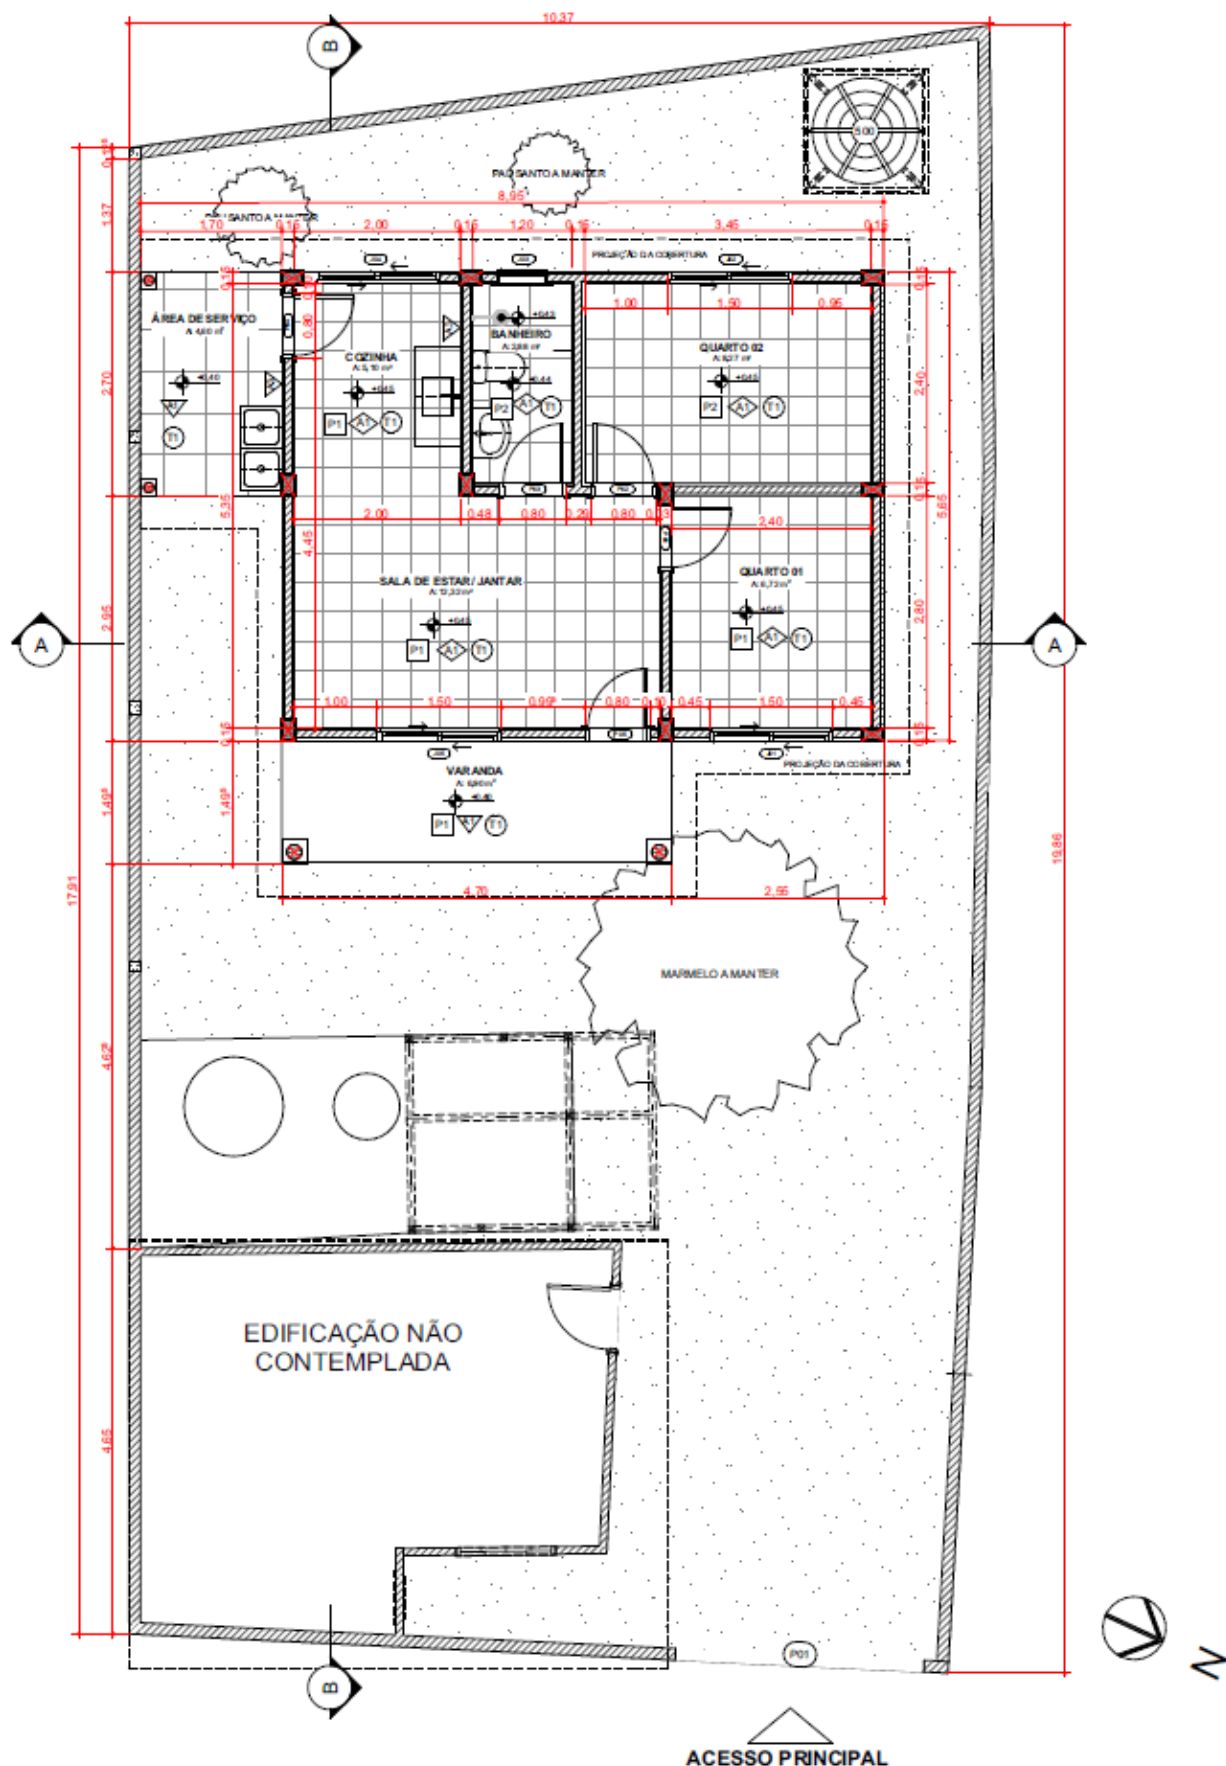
Planta baixa da solução arquitetônica da ATNH-1 aprovada pela família
